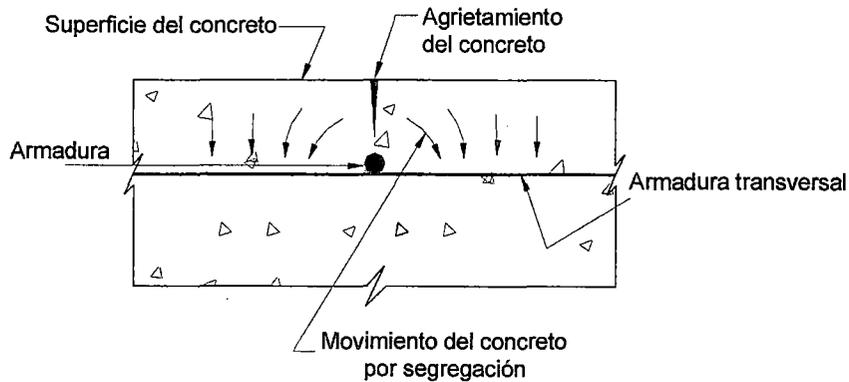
Grietas en el concreto a causa de la segregación.
